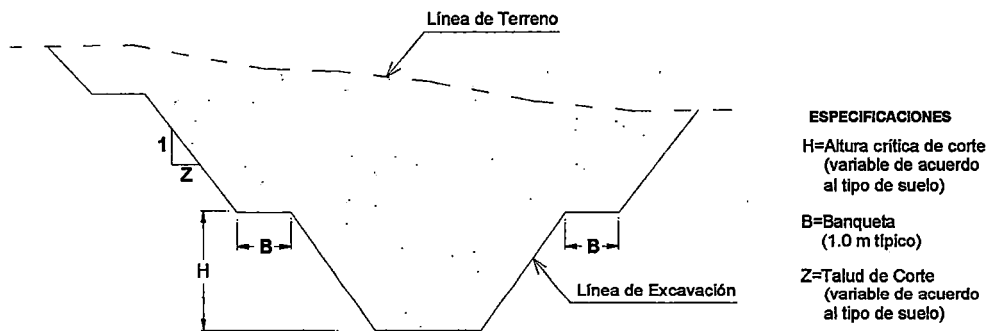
Corte Mediante el Sistema de Banquetas
